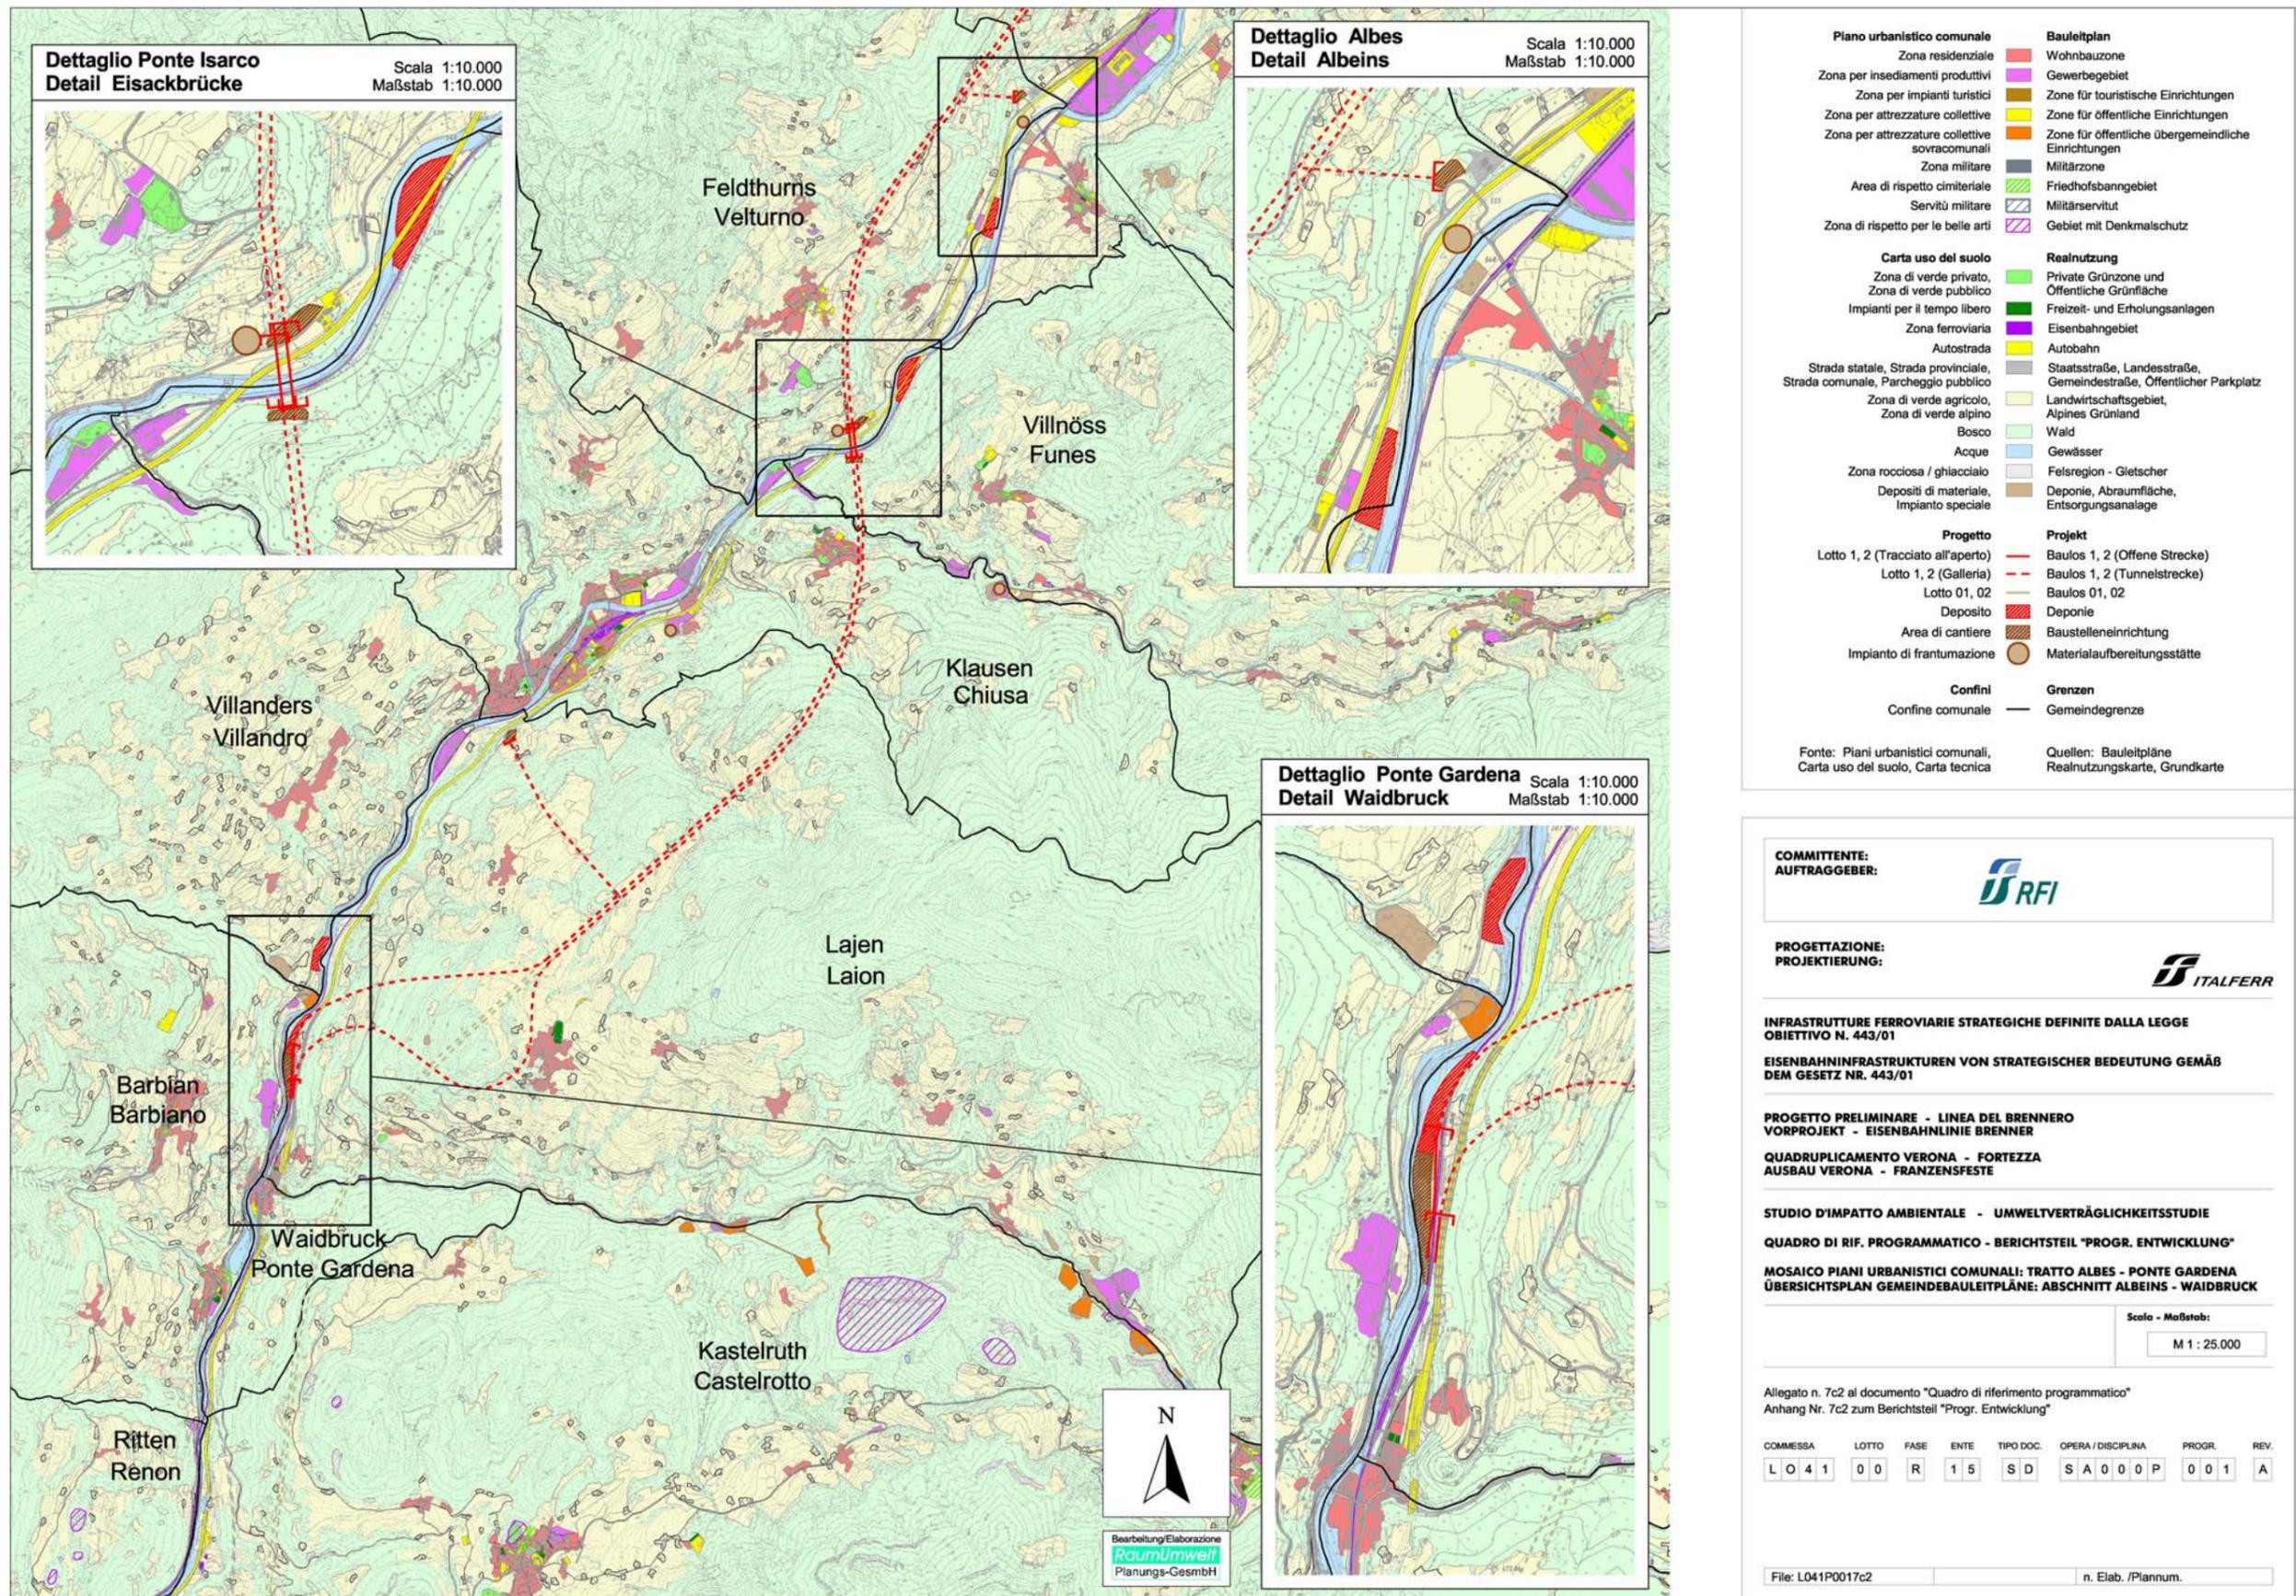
Tracciato, depositi e aree di cantiere nel tratto tra Bressanone e Ponte Gardena (Lotto prioritario I).
